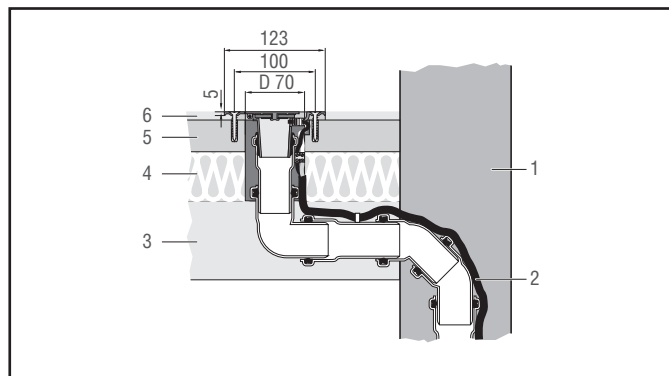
Схема монтажа труб при прокладке в бетоне
